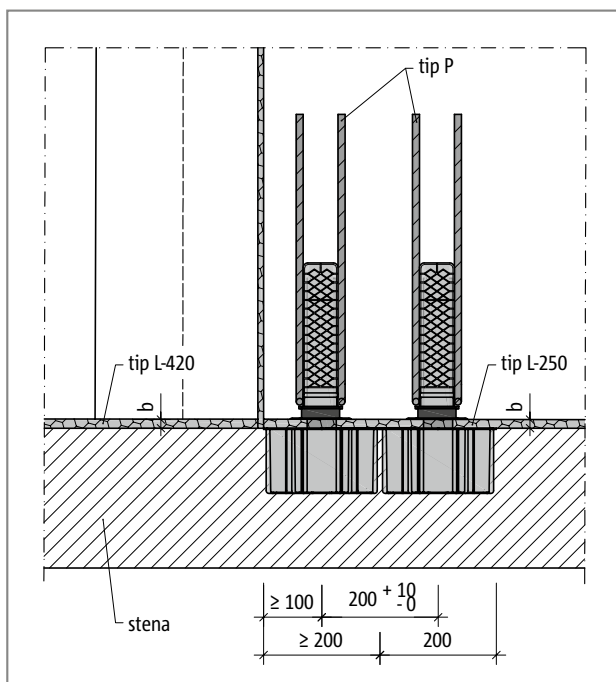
Schöck Tronsole® tip P: razporeditev elementov, detajl B
